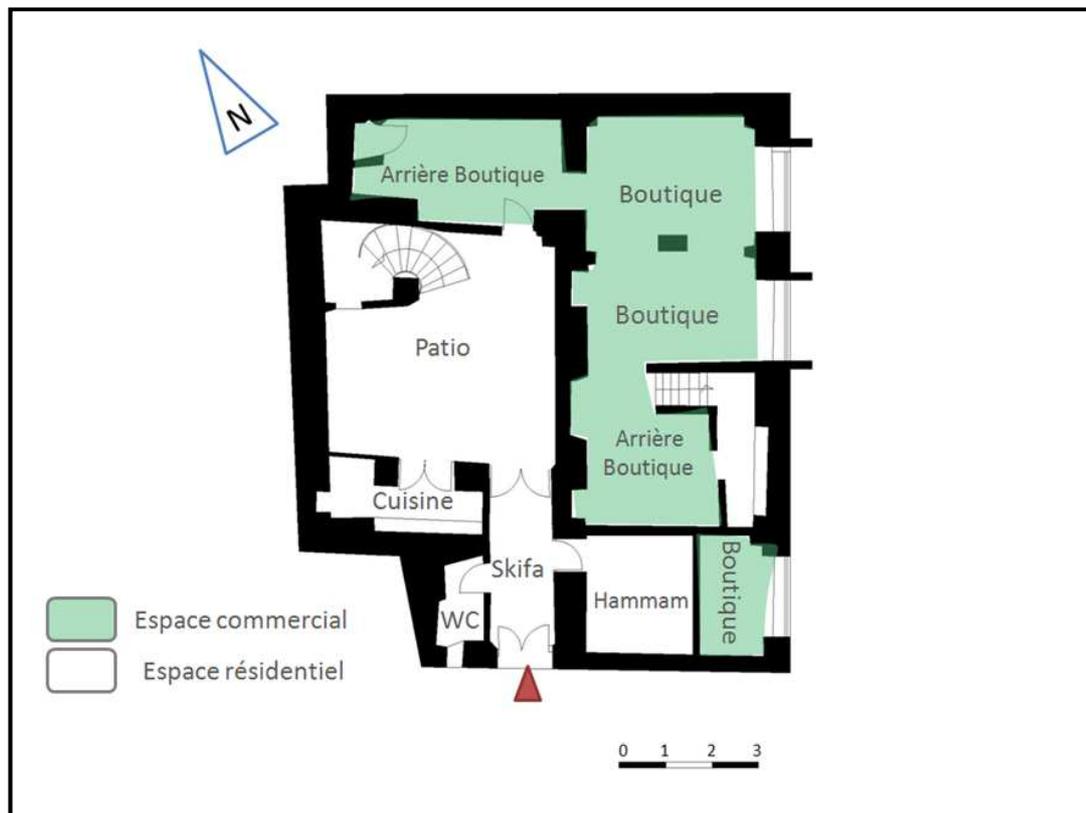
118 : Plan rez-de-chaussée : schéma fonctionnel. Source : auteur, 2011.
